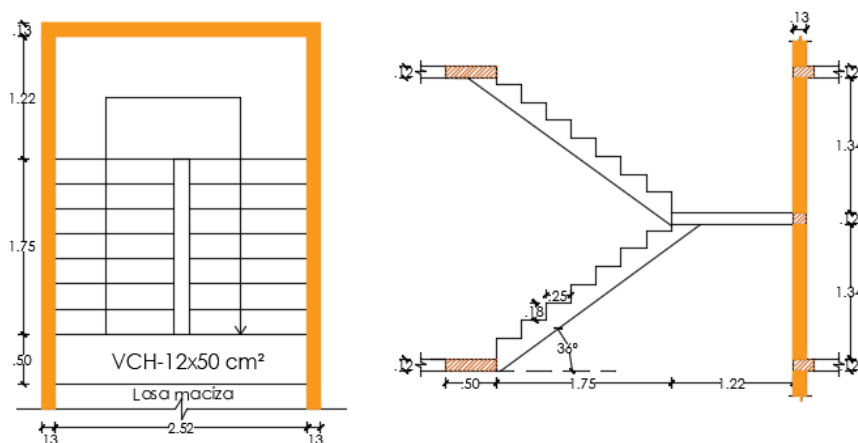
Elevación y planta de escalera. Fuente: Elaboración propia.
